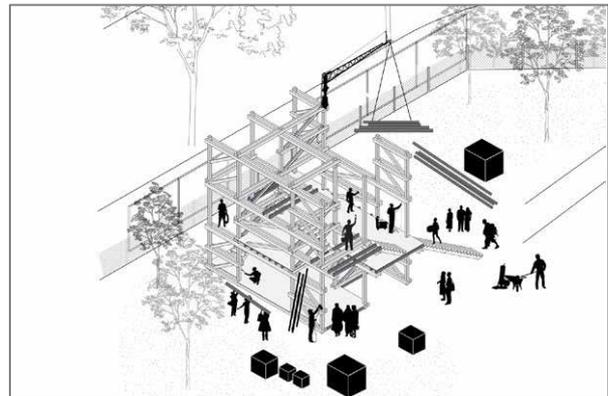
Werkstatt mit ersten Versuchen zum Holzaufbau mit Flaschenzügen
